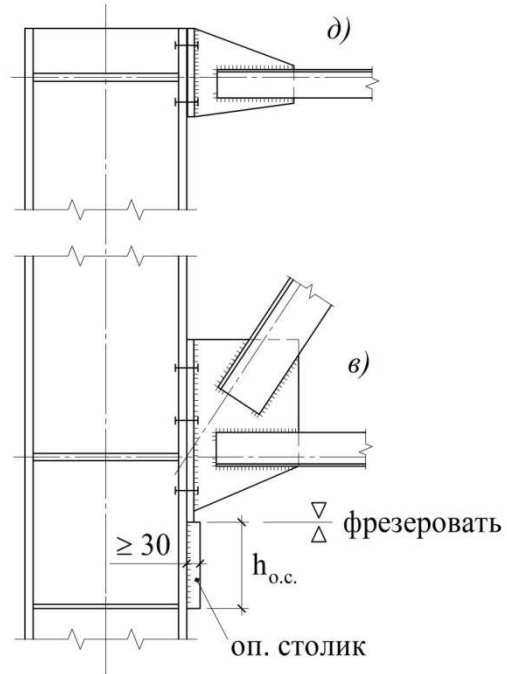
в, д. Вариант опорных узлов фермы при опирании ее на колонну сбоку на фланцах
